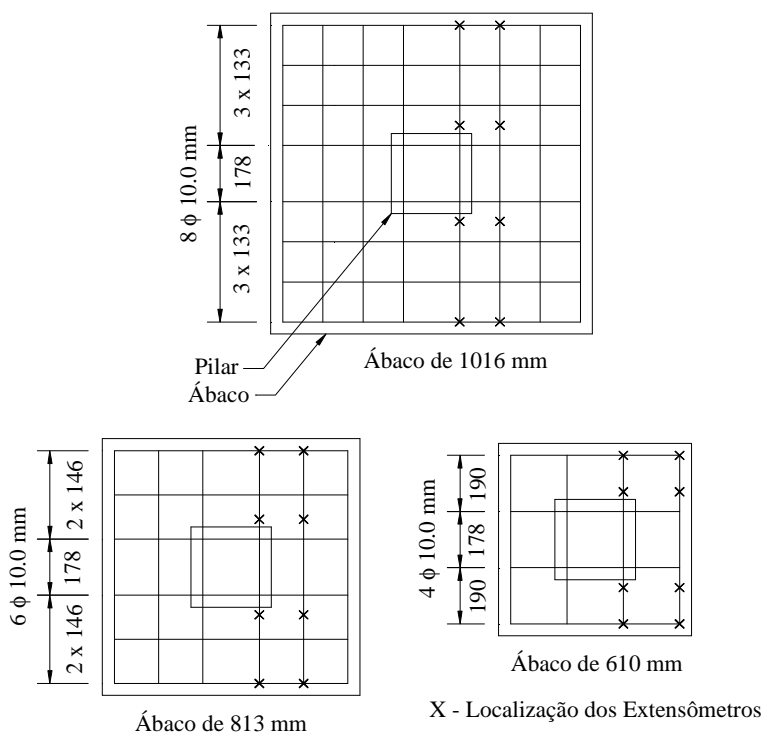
Armadura das lajes vista em planta, para pilar central (WEY, 1991)
